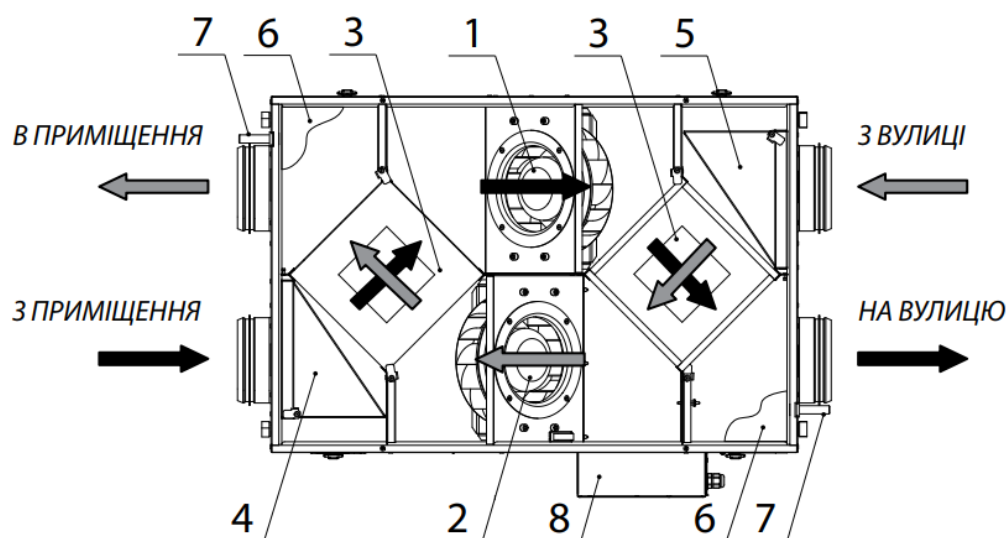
Схема компоновки припливно - витяжної установки
